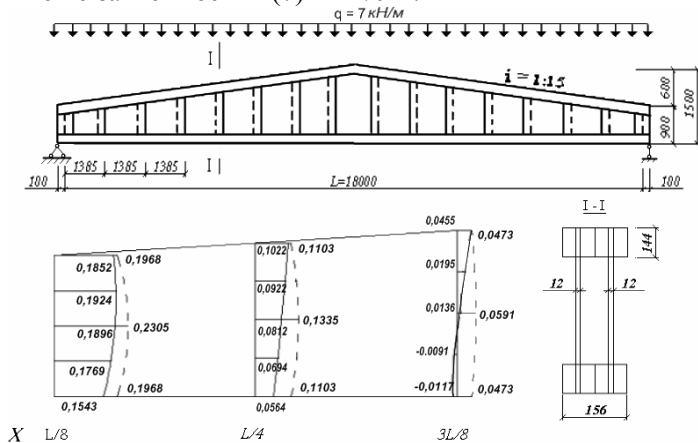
Конструкция балки и эпюры касательных напряжений по высоте стенки деревофанерной балки:
